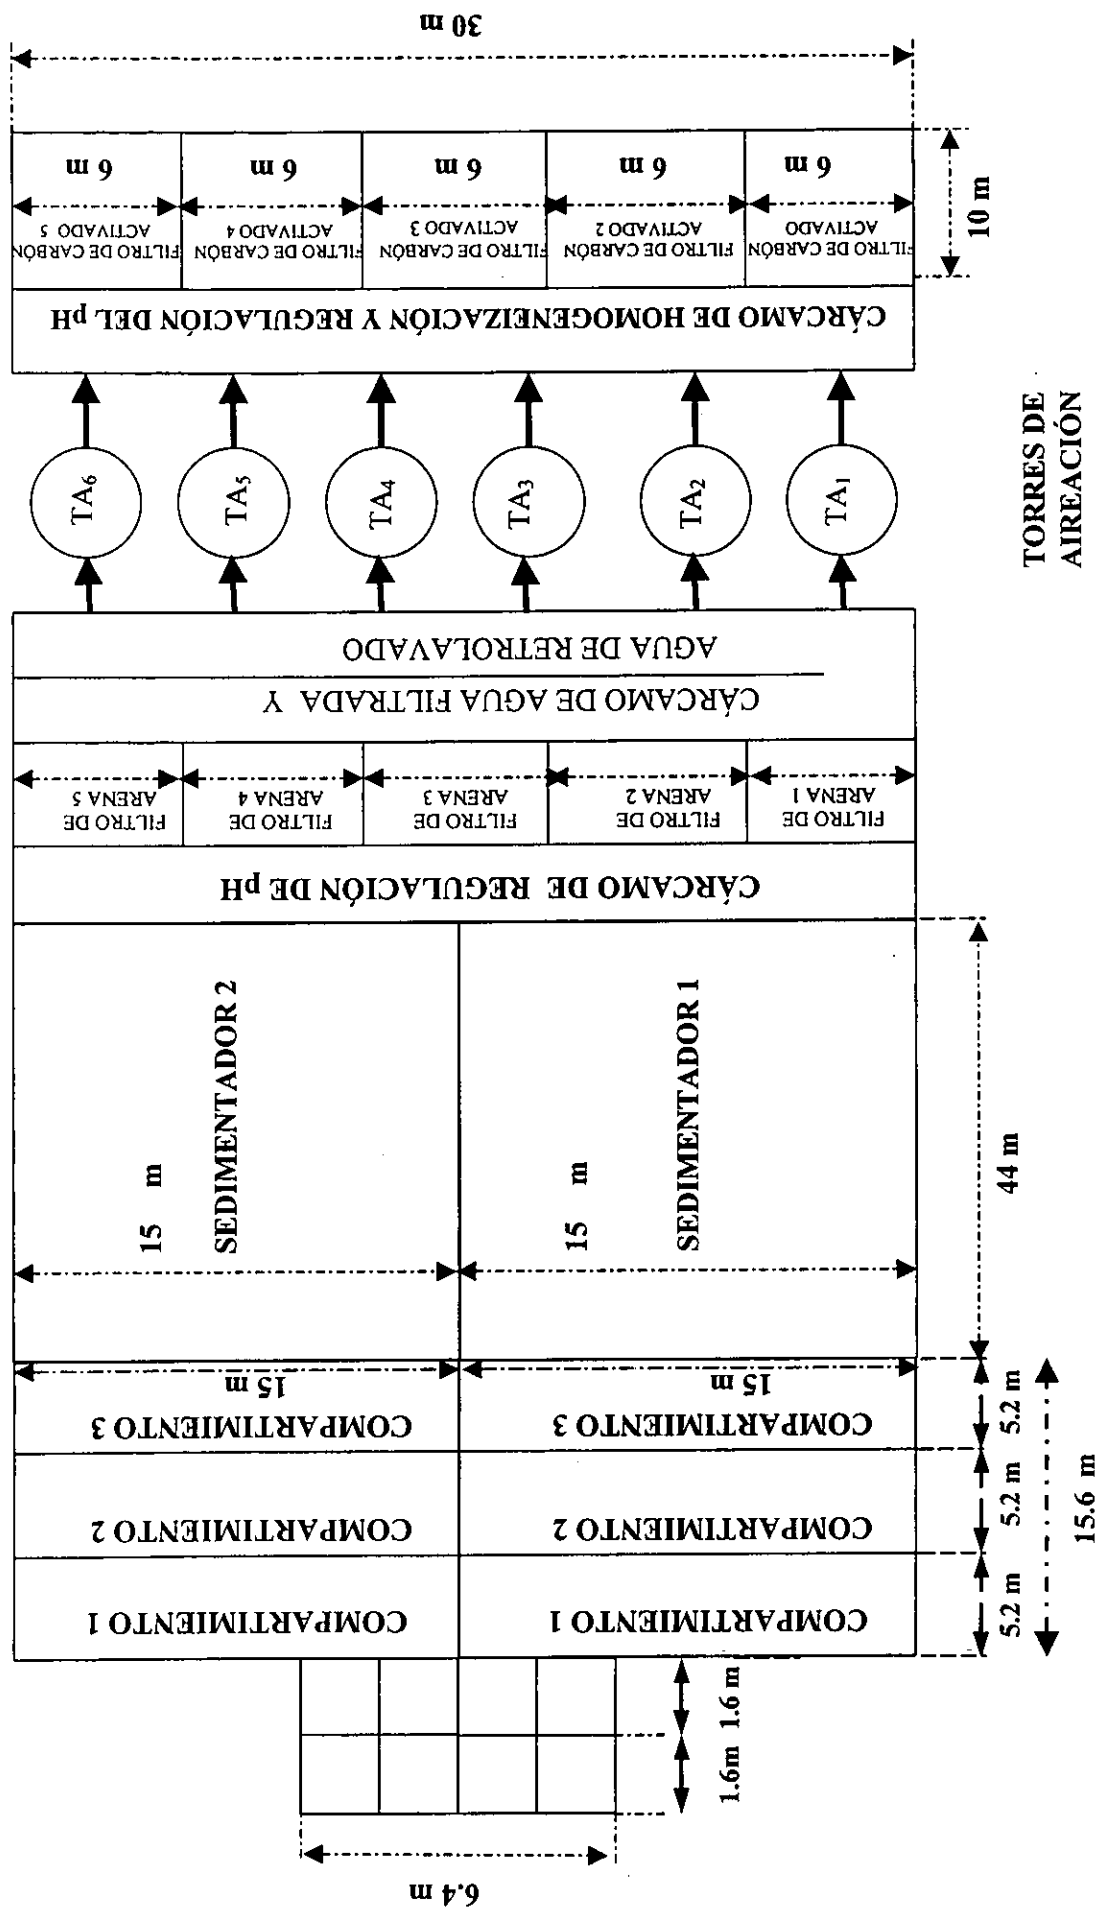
Vista superior de la planta de tratamiento propuesta
